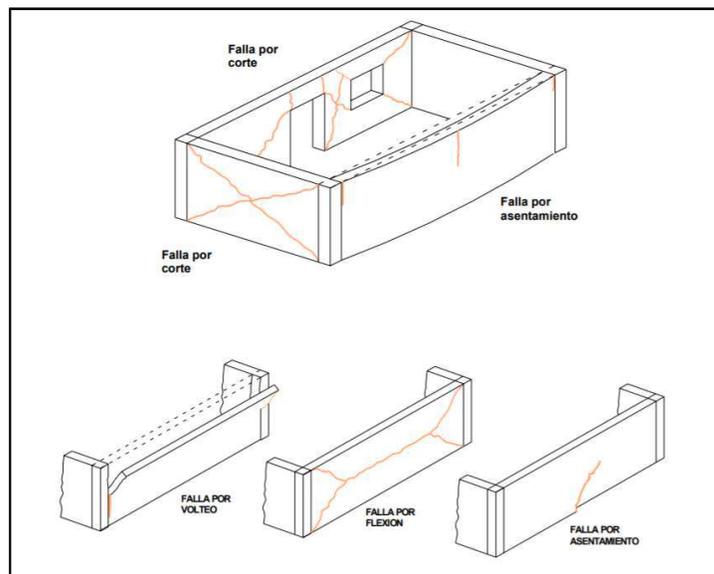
Grietas estructurales (Iglesias y Robles 1988)
